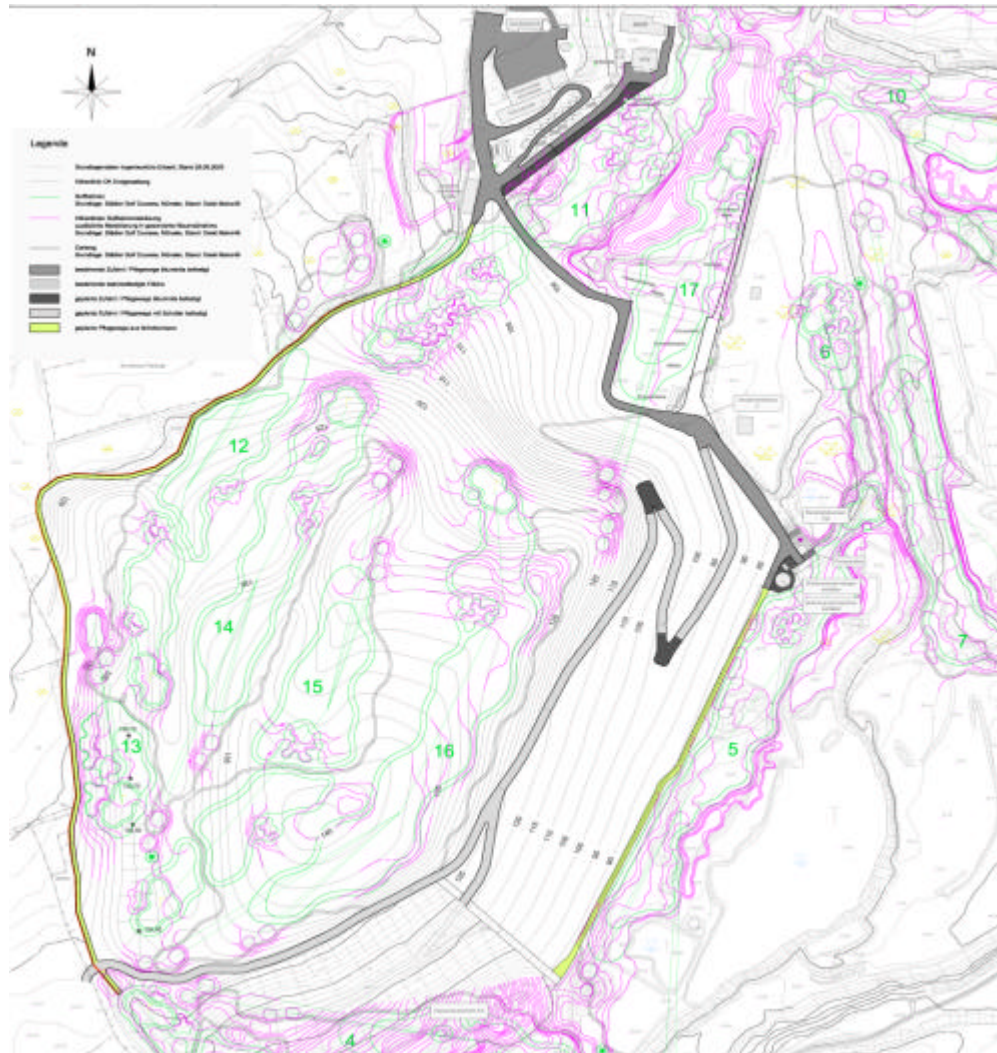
Lageplan Oberflächengestalt mit Darstellung der Golfbahnen
